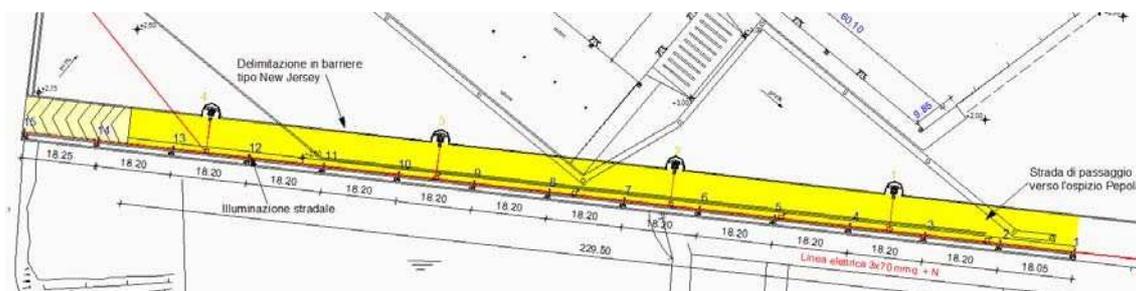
Planimetria della viabilità definitiva verso l'Ospizio Pepoli
